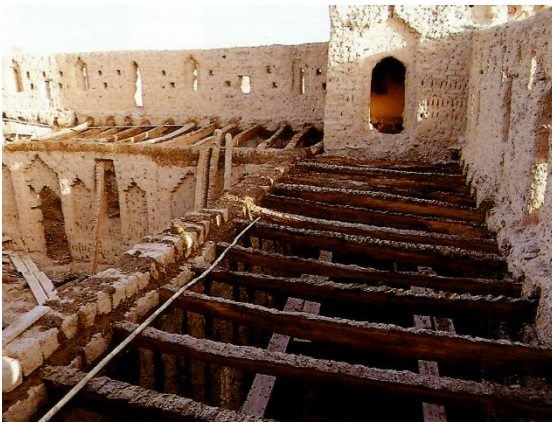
Detalle de la cubierta plana a base de vigas de madera en Ben Moro, Skoura.
